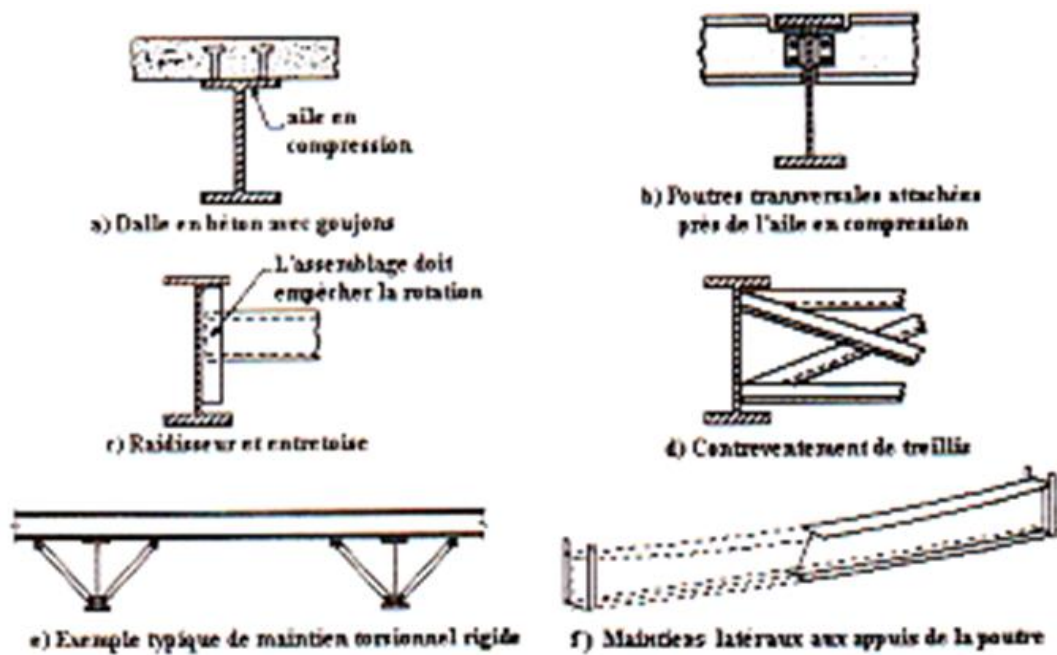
Exemples de maintien latéral d'une poutre fléchie
